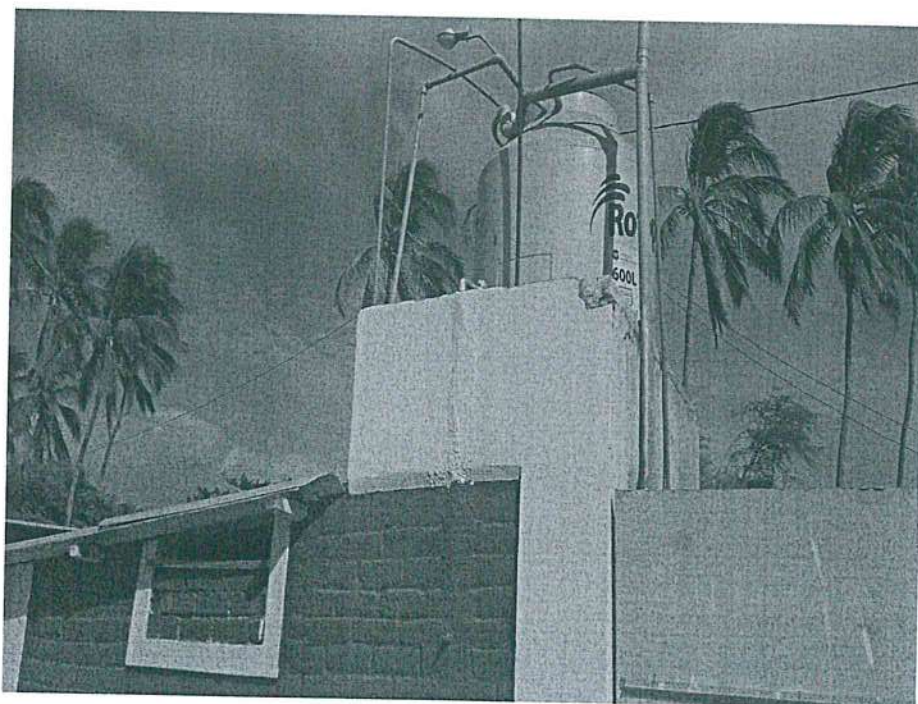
Fisuras en armazón de anqué elevado que se encuentra sobre la cobertura de SS.HH. la cual ni cuenta con estructura y función con muros portantes.
